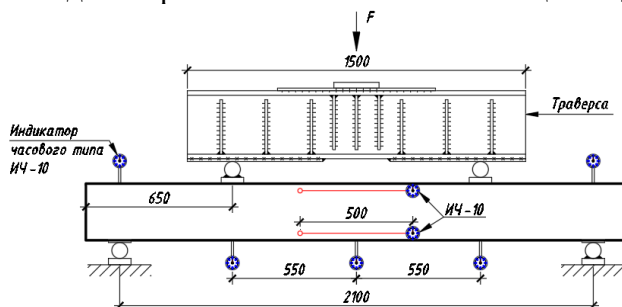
Схема проведения испытаний железобетонных балок на изгиб
